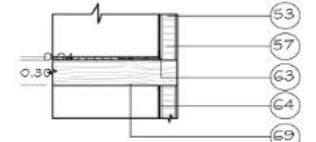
Detalle 13 (Techo)-Esc:1/20. Fuente: Elaboración Propia.
